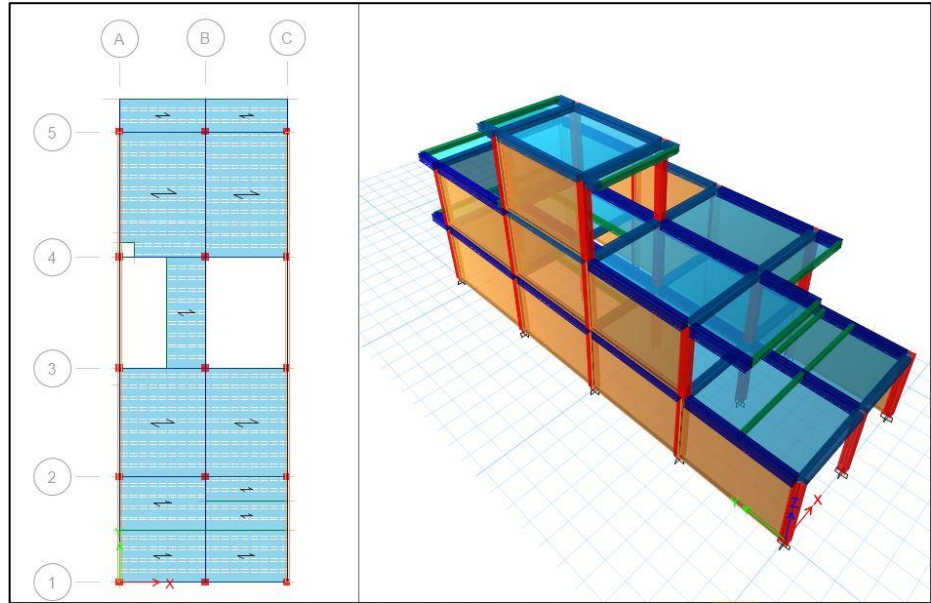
Vivienda Informal de 2 Pisos (HU-5), Vista en Planta (Izquierda) y Vista 3D (Derecha)
